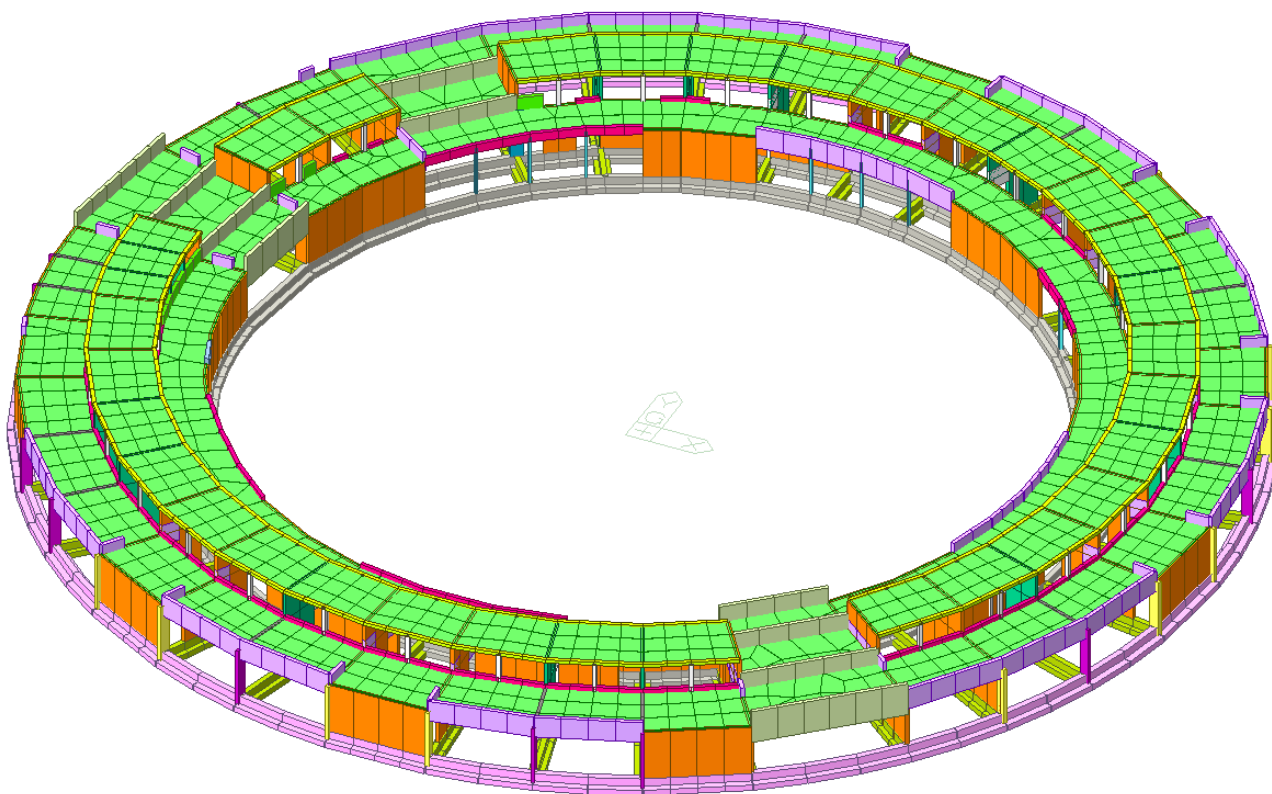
Immagine 3D del modello di calcolo ad elementi finiti delle strutture di fondazione
